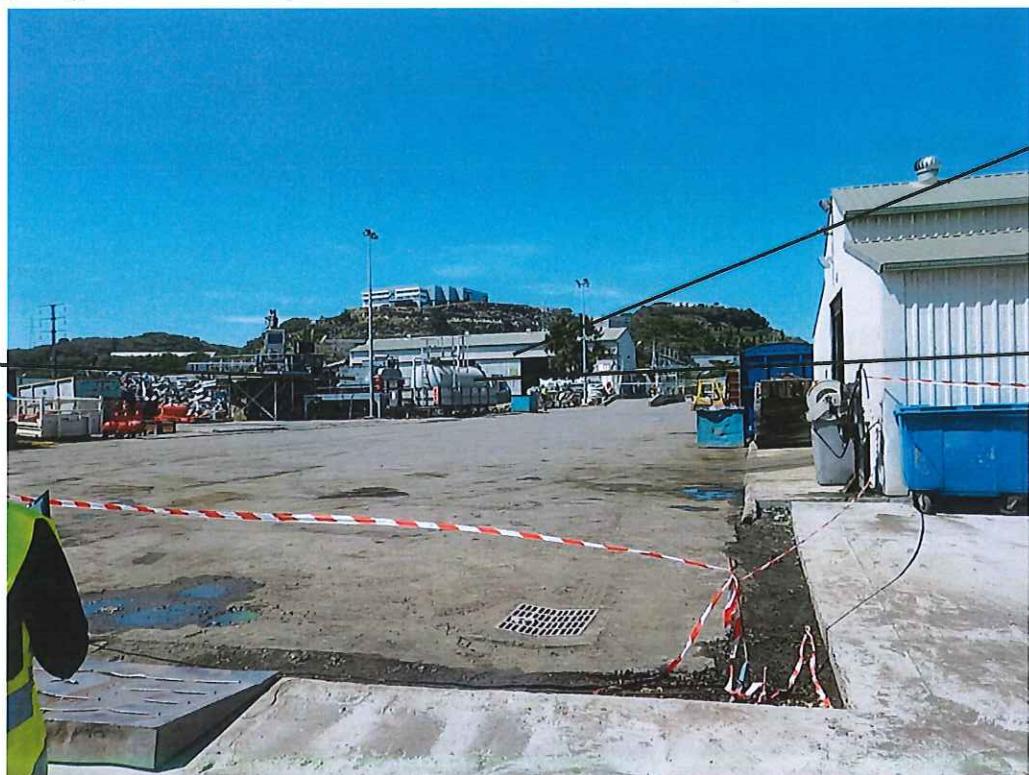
vue générale du site depuis la zone revêtue de la tranche 1A (vue en direction du Sud-Est)
